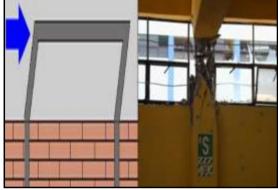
Agrietamiento de muros de mampostería.
